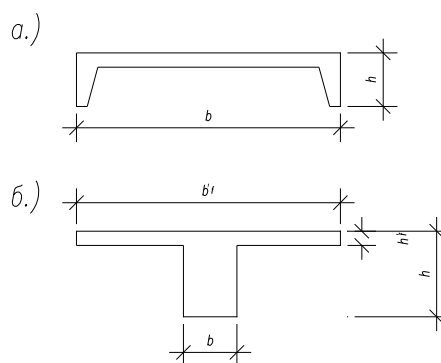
К расчету прочности плиты по нормальным сечениям
